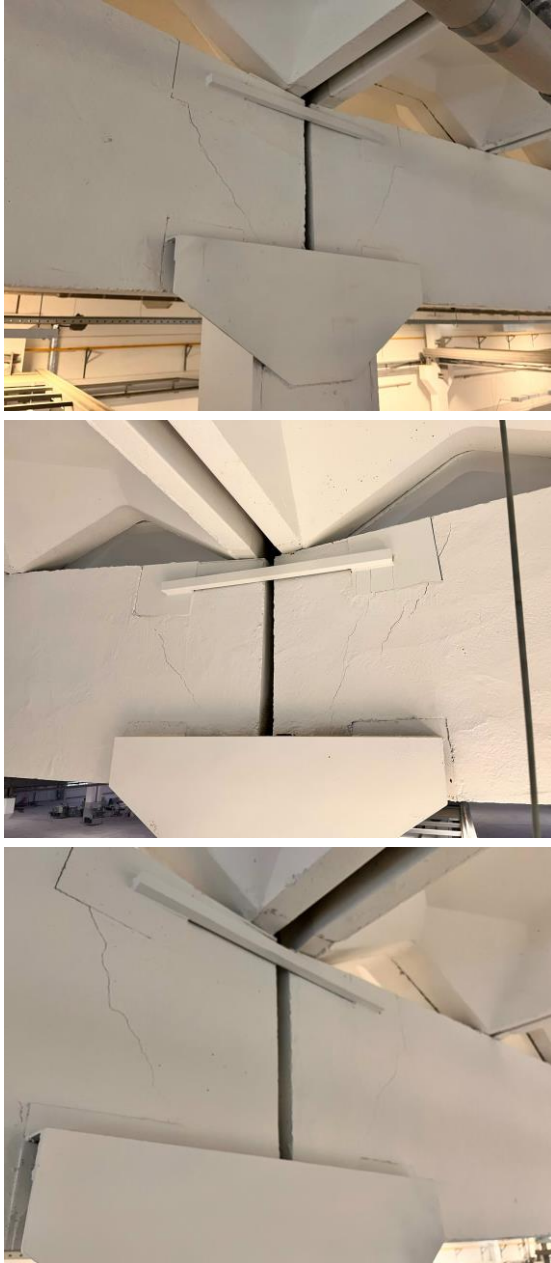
Сквозные трещины в верхней части опор стропильных балок
